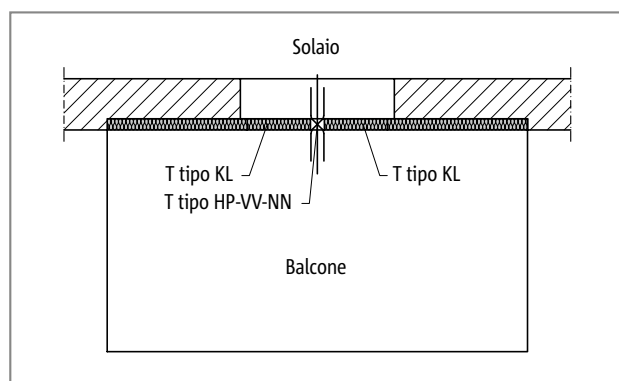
Schöck Isokorb® T tipo HP: balcone a sbalzo
